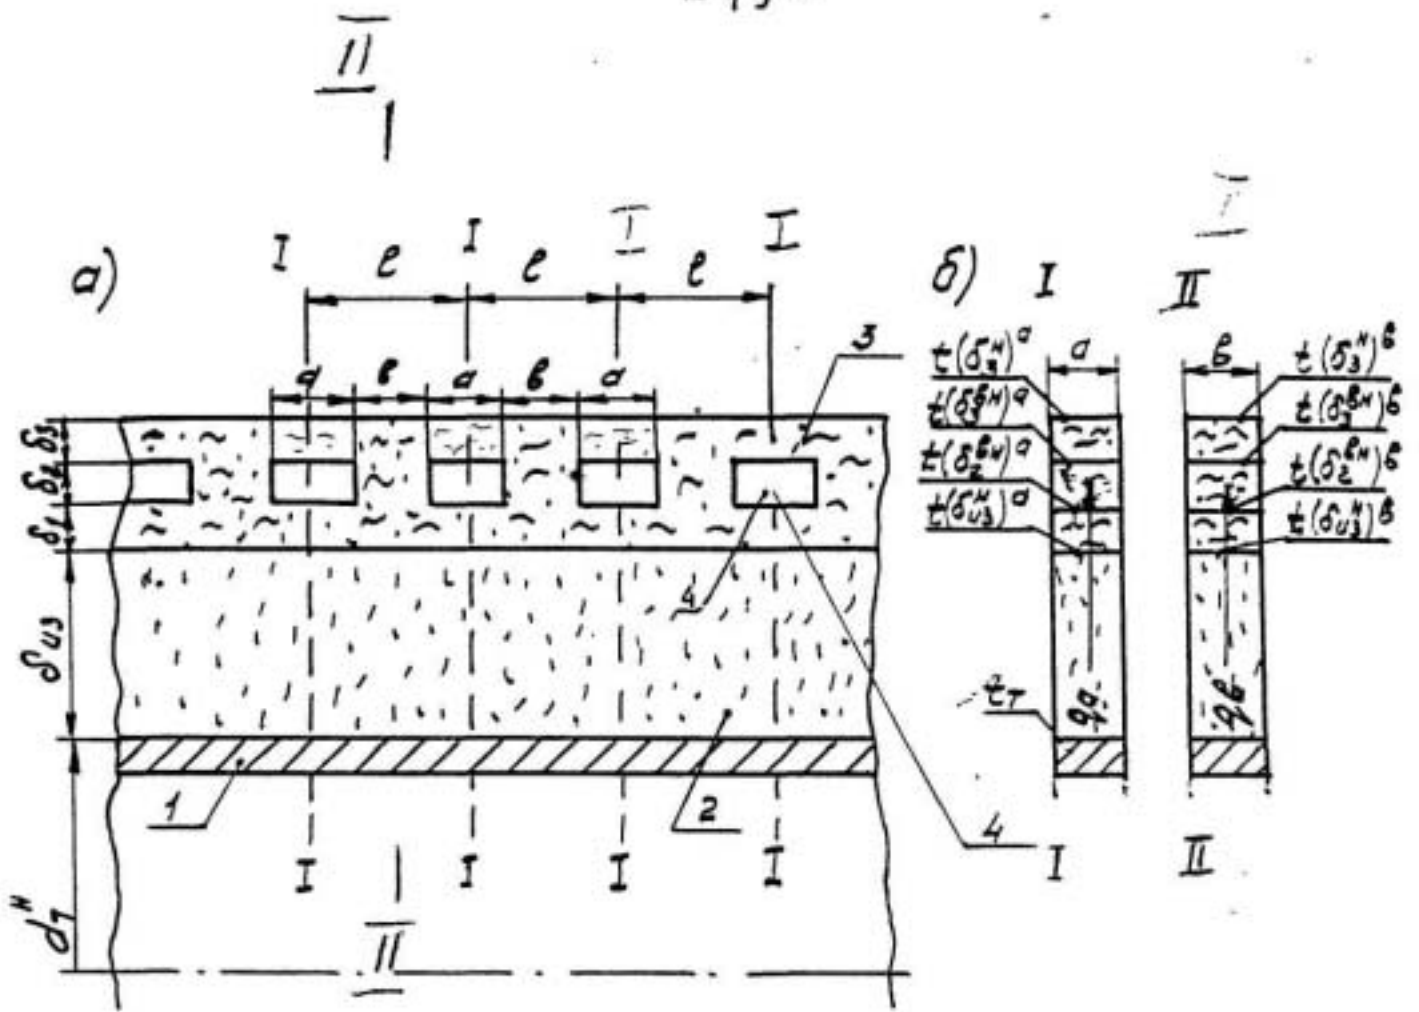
а Схема теплоизоляционной конструкции трубопровода;
